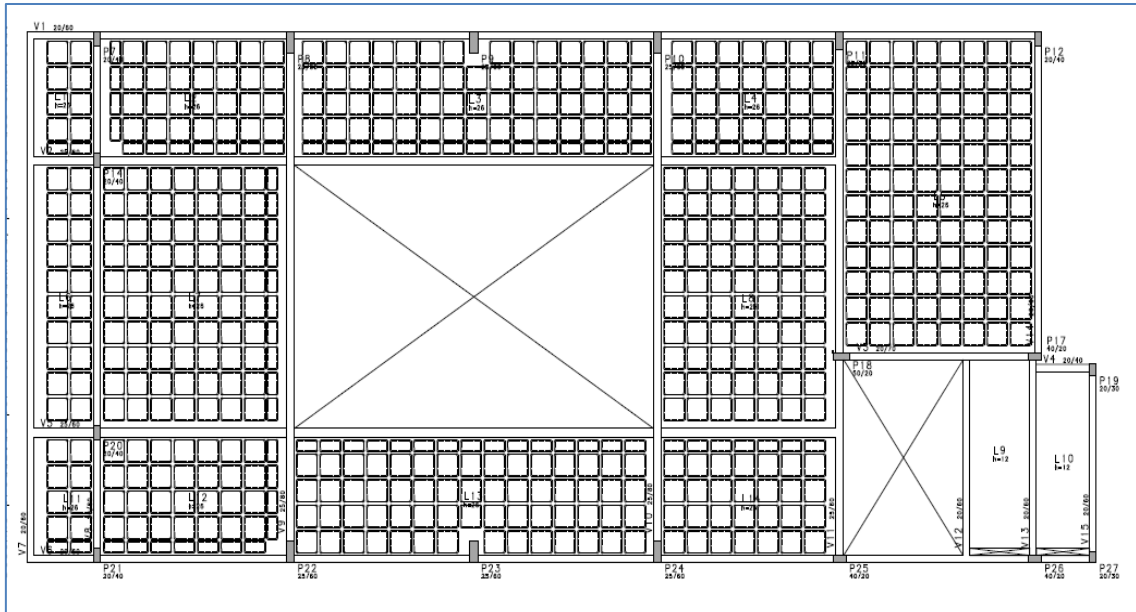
Planta de fôrma: 1º pavimento, concreto protendido (CAD/TQS)
